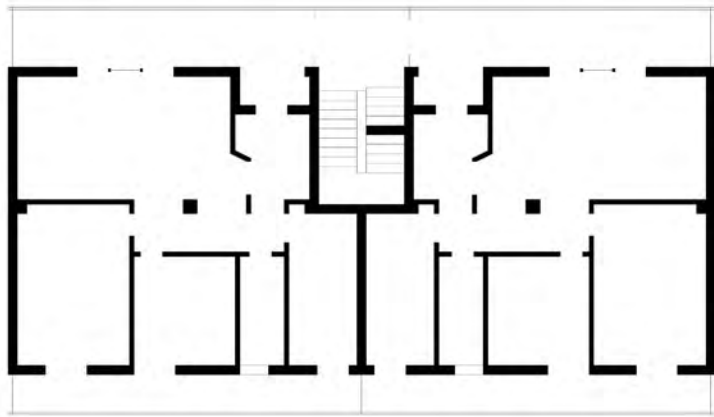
Pianta piano terra (Fonte: elaborazione dell'autore).
